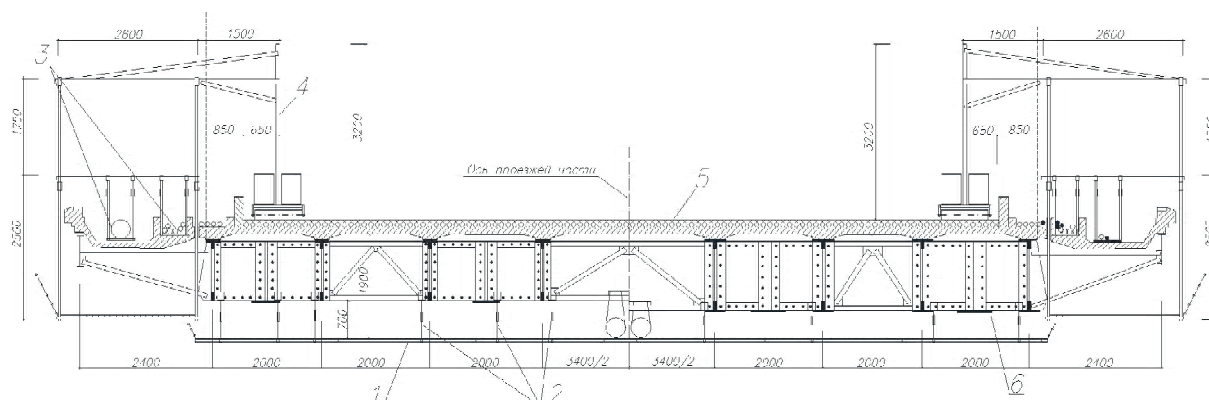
Схема устройства подвесных струнных лесов при реконструкции пролетных конструкций моста: 1 – рабочий настил подвесных подмостей; 2 – подвески подмостей; 3 – трубы коммуникаций; 4 – консольно-балочная система; 5 – полотно моста; 6 – реконструируемые стальные балки.
